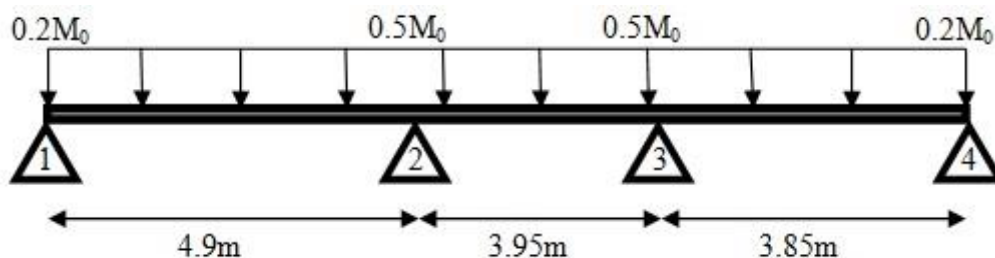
Schéma statique de poutrelle (2<sup>ème</sup> type étage).
